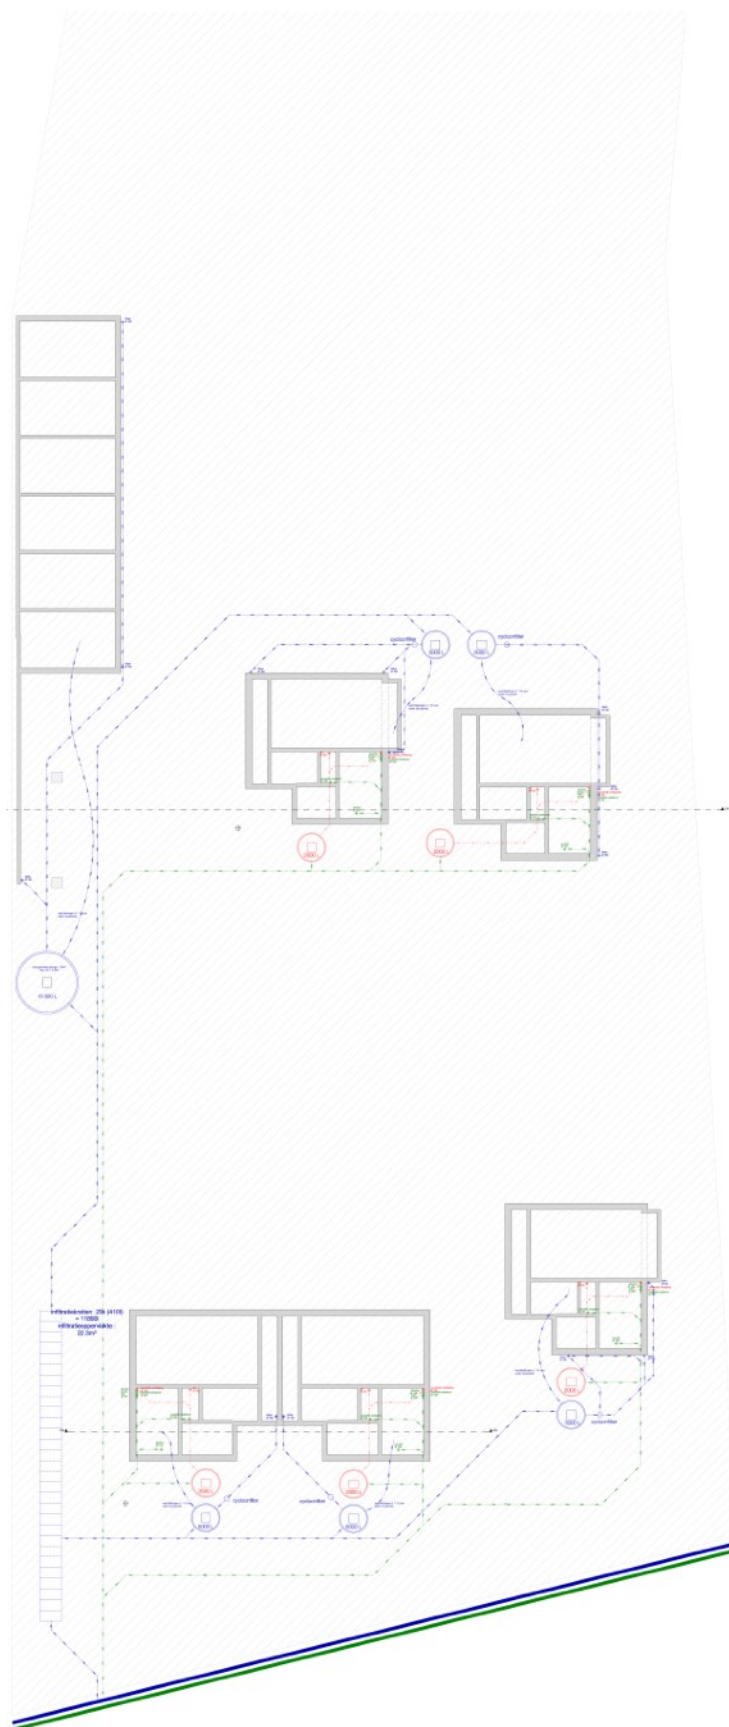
Kelderplan & rioleringsplan. © Architectenburo Jef van Oevelen bvba
